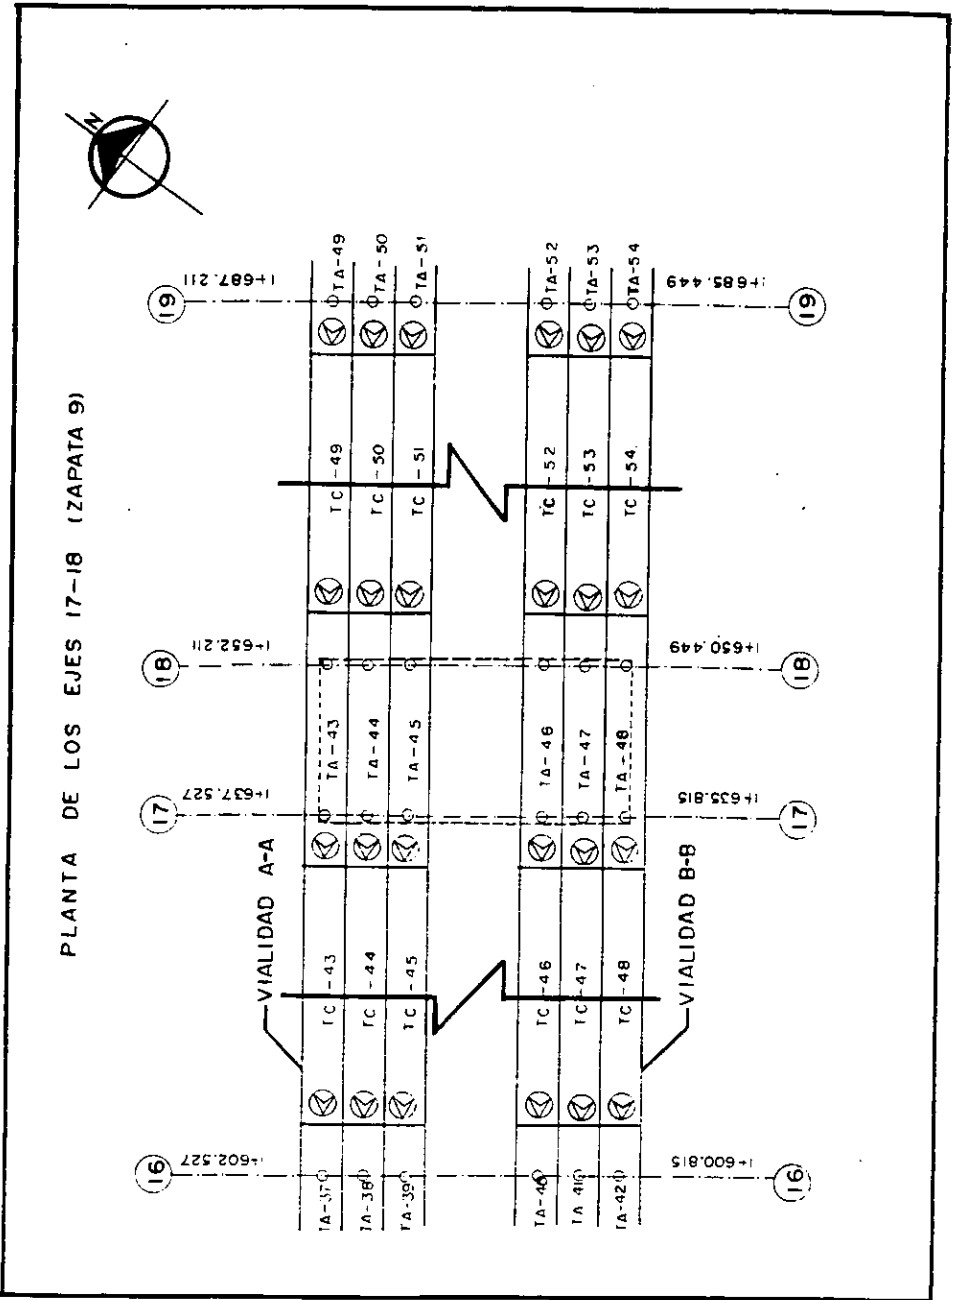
Planta de la zapata 9 (Ejes 17-18)
